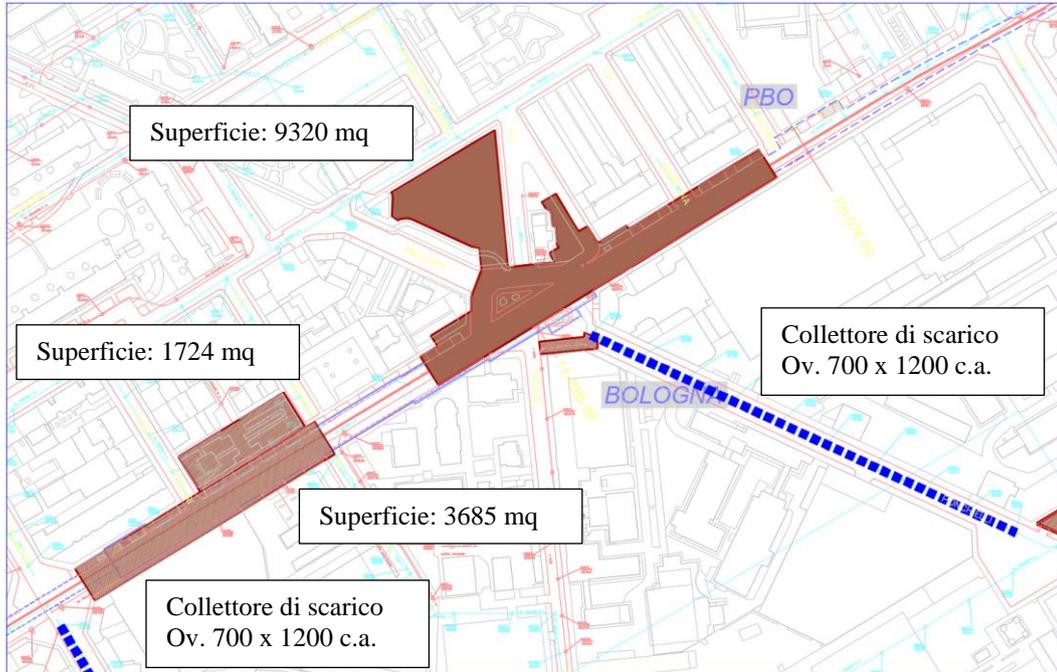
Aree di cantiere – Stazione Bologna – FASE 3A
